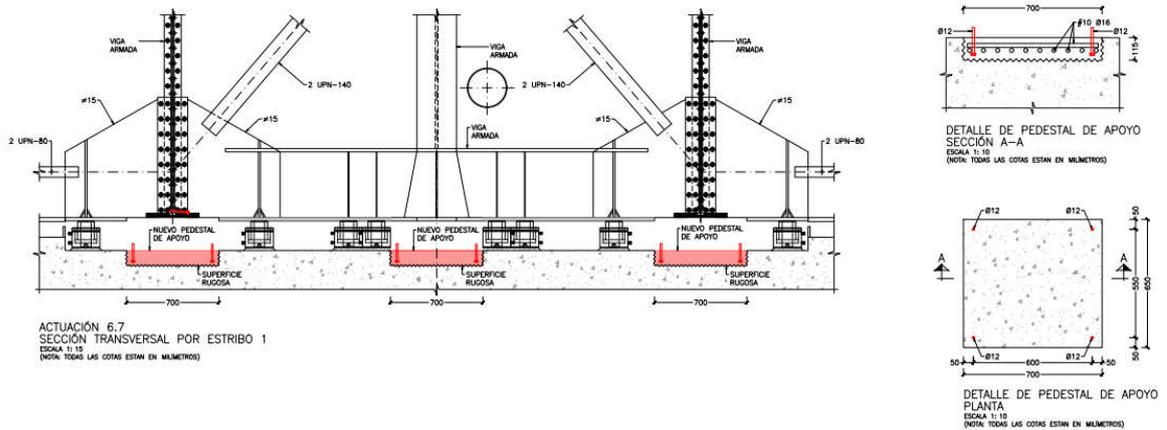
Colocación de armadura y anclajes en pedestal de apoyo
